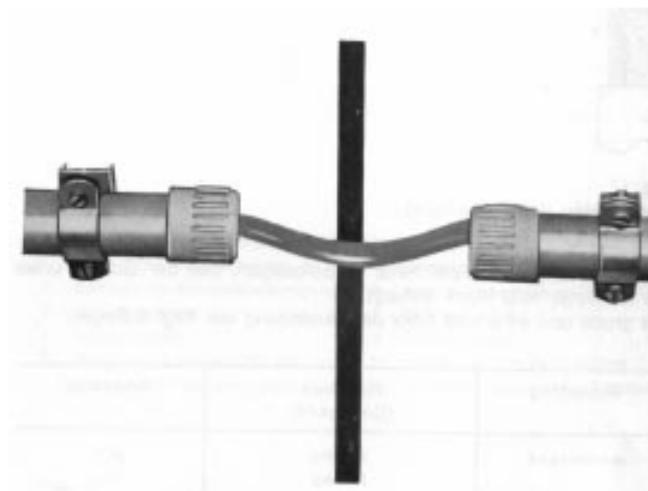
Interruzione del tubo di protezione su un giunto di dilatazione
